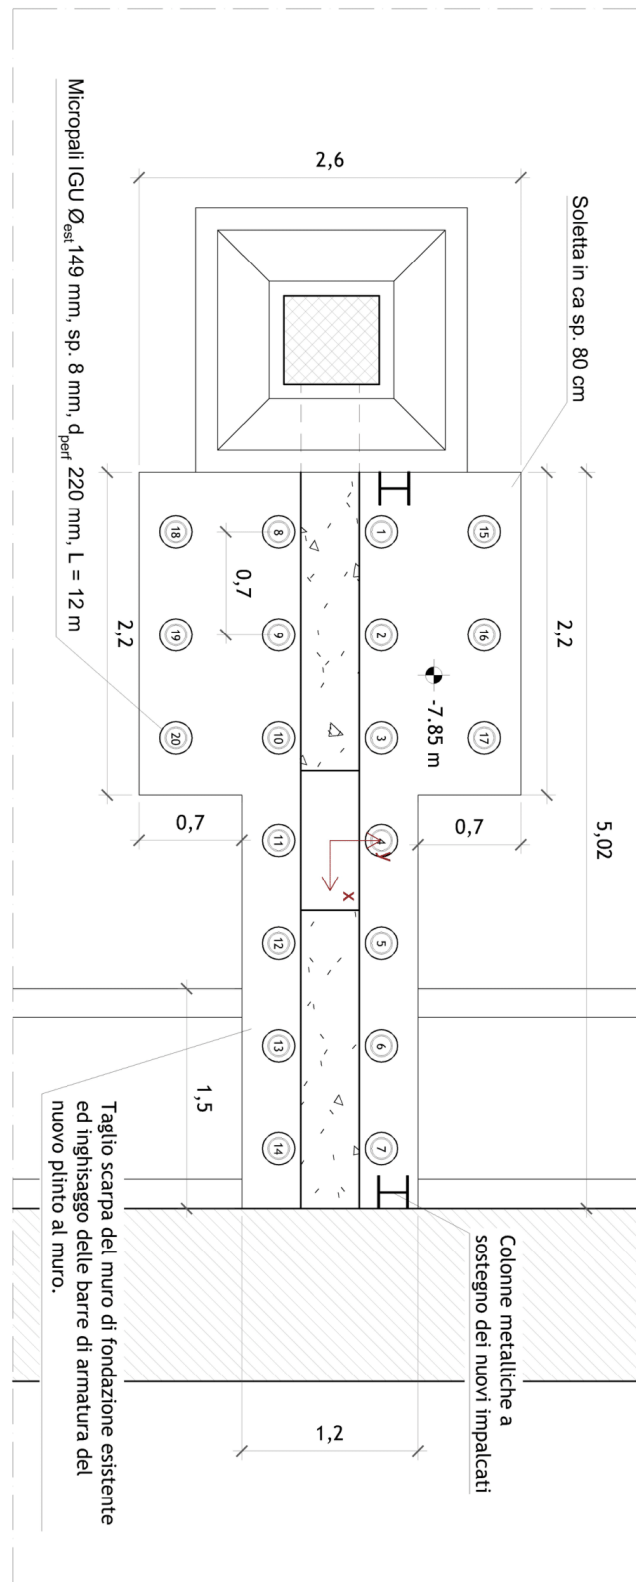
Disposizione planimetrica dei micropali - setto BCC.
